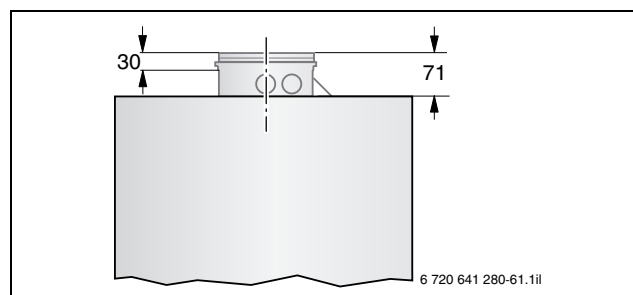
Монтажные размеры коаксиального патрубков для присоединения котла (размеры в мм)
